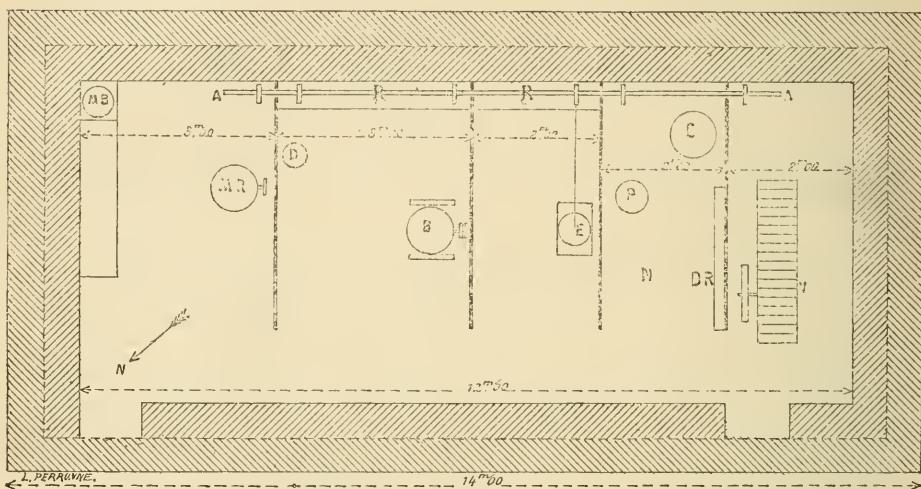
Plan d'une laiterie pour le traitement de 500 litres de lait par jour.
